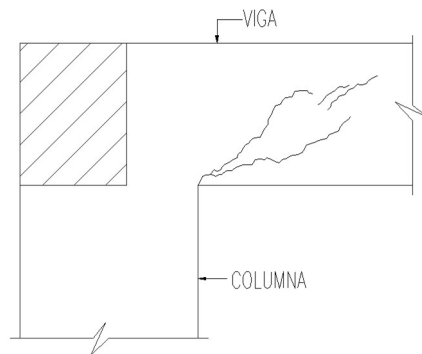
Fisuras en apoyo de vigas de cubierta (archivo propio)
